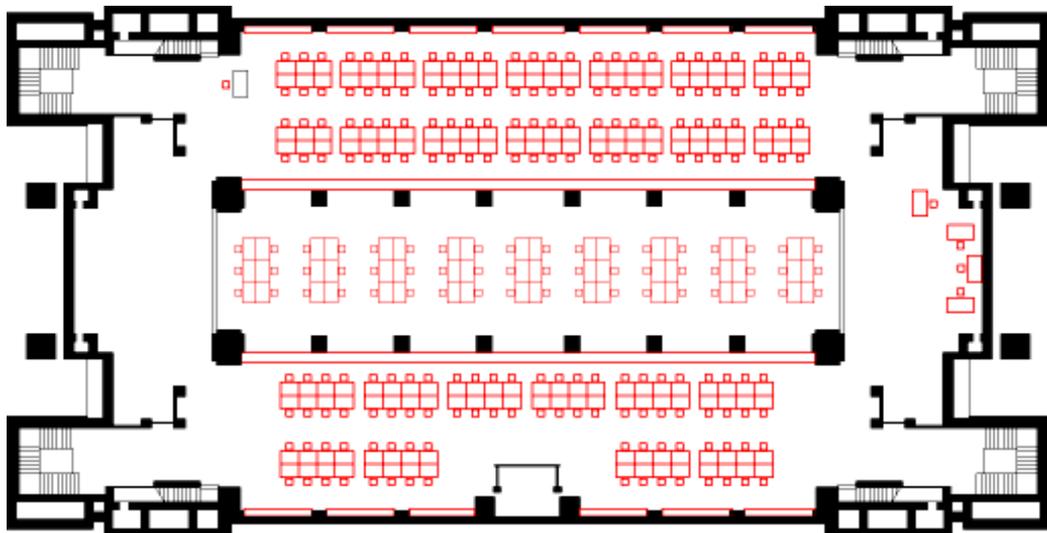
Planta Larkin Building sem escada, Buffalo, EUA
